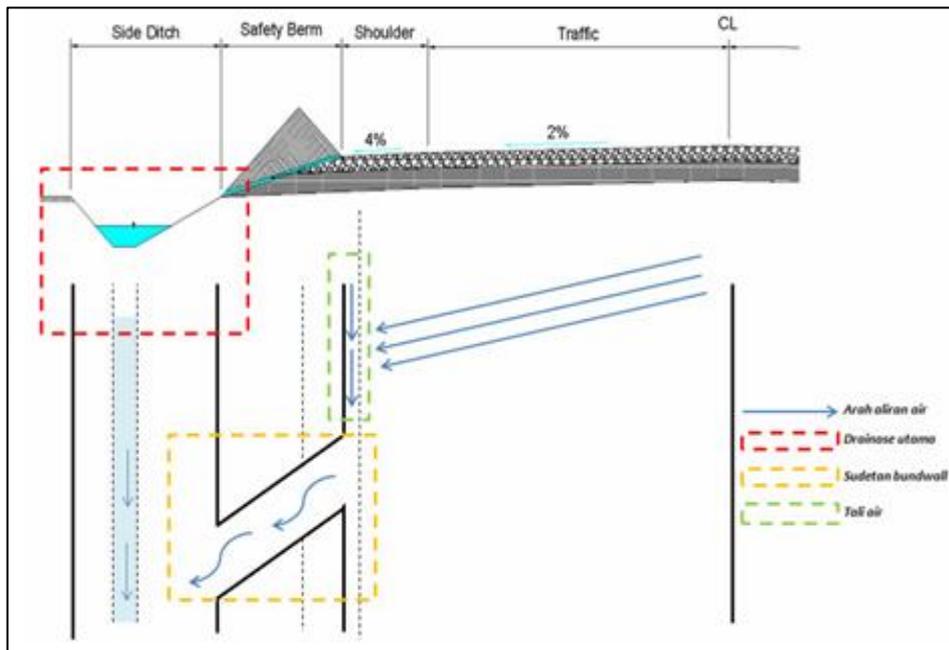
Desain Tipikal Potongan Melintang Jalan
